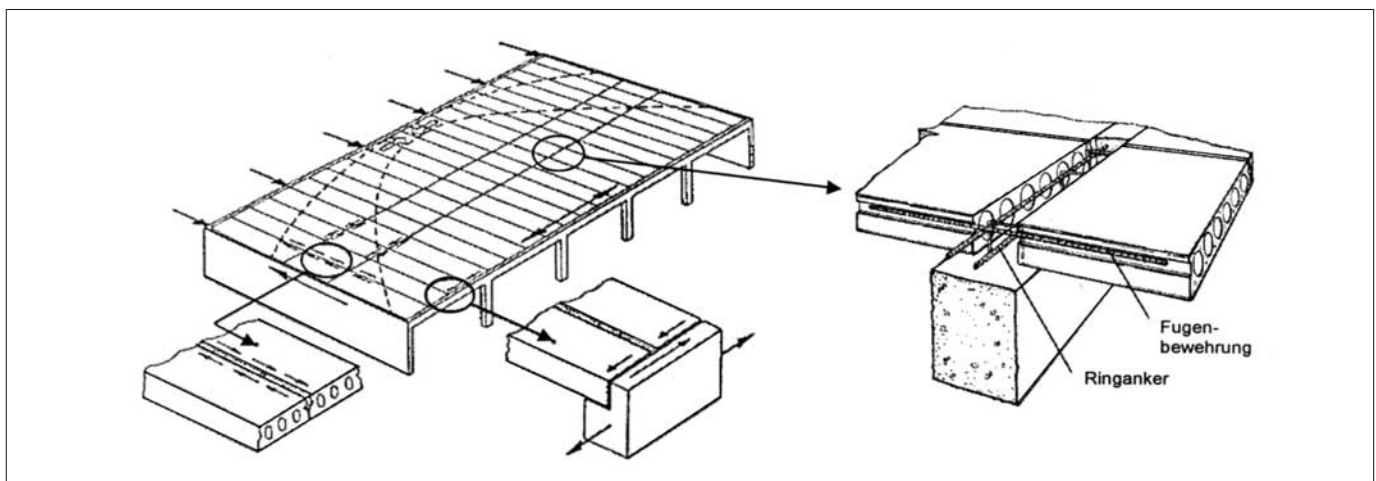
Bemessung und konstruktive Durchbildung der Deckenscheibe
